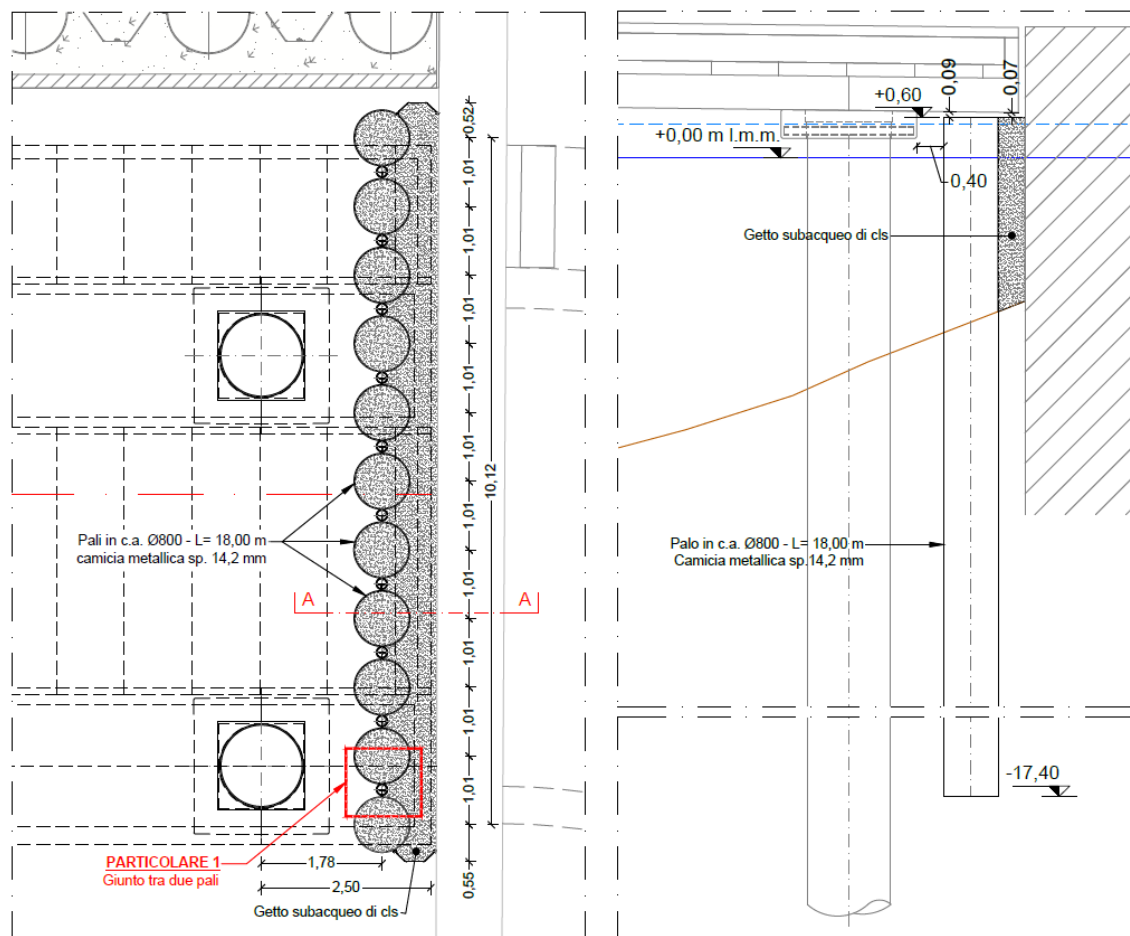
Consolidamento Banchina molo Nord: planimetria e sezione
